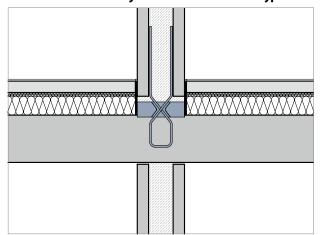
Schöck Sconnex® type W mur extérieur sur radier
